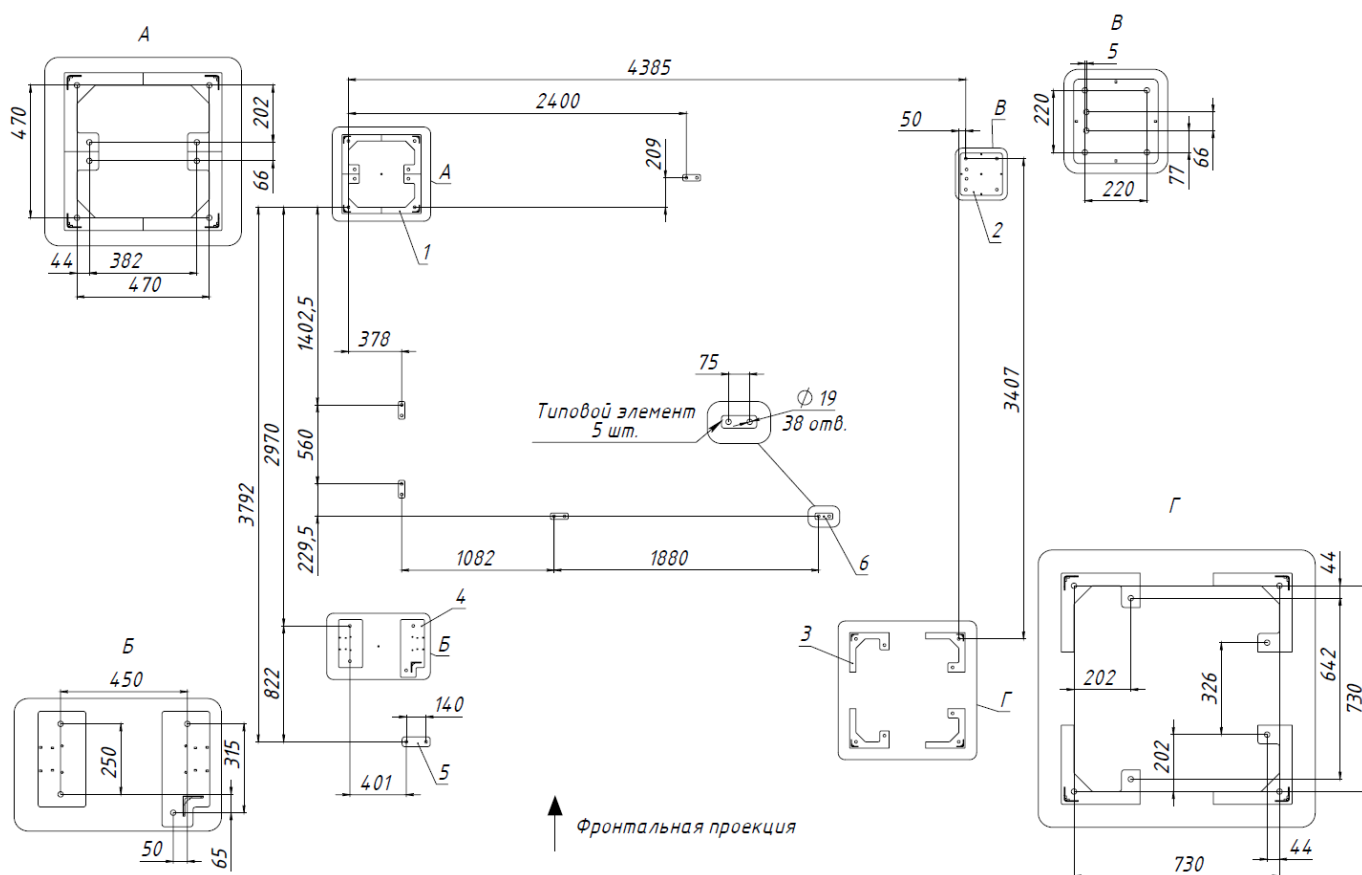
Схема расположения отверстий под анкеры. 1 – Стойка С2, 2 – Стойка С3, 3 – Стойка С4, 4 – Стойка С1, 5 – Лестница Л1, 6 – Стойка С5
